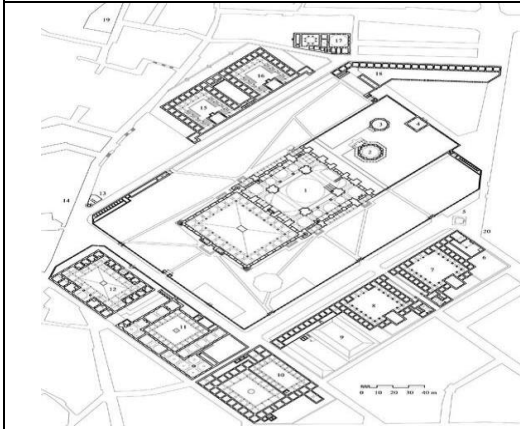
مسقط أفقى لكلية شاه زاده محمد
